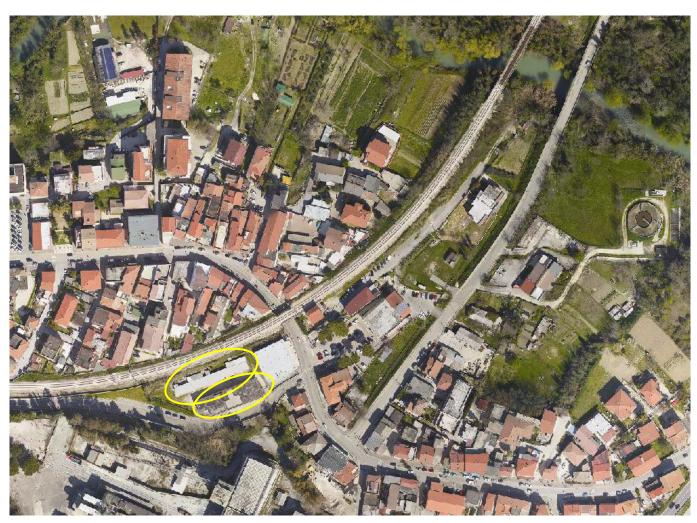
Vista planimetrica Fabbricati 40 – 41
